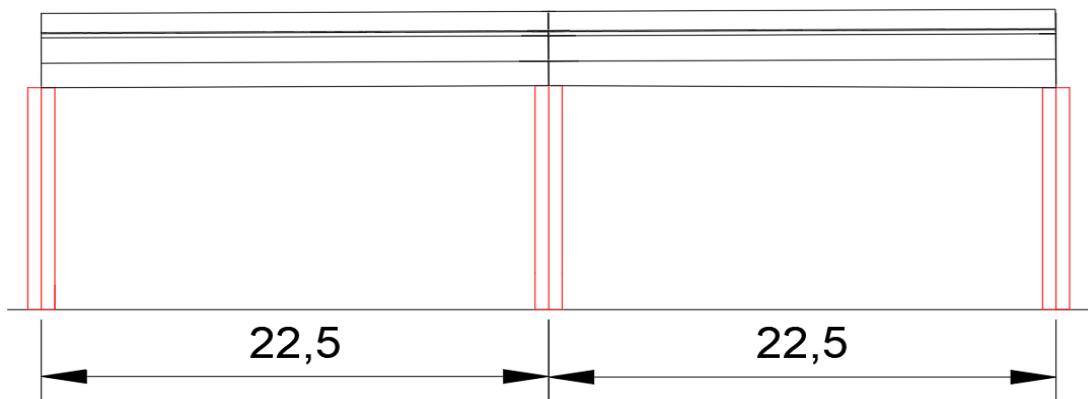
De izquierda a derecha: pila#11, pila #12 y pila #13 presentes en el tramo 2; Unidades en metros. Fuente: Elaboración propia de autor
